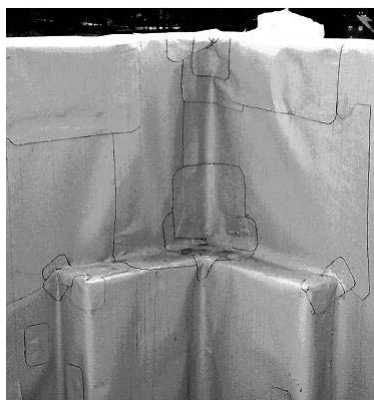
Крепление ПВХ-мембраны к бетонному основанию [3]
